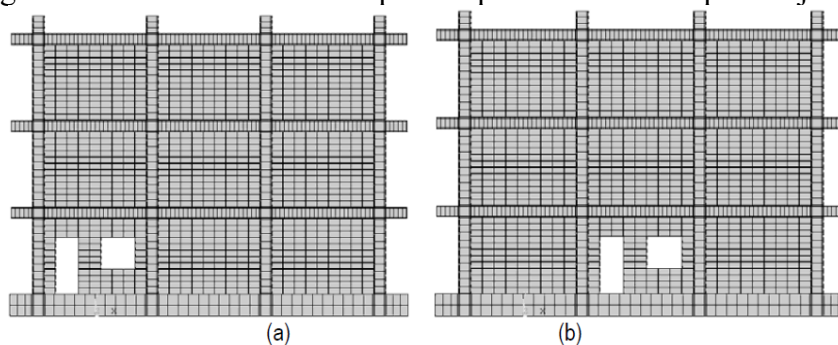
Fissuras observadas nos dois edifícios ensaiados.
